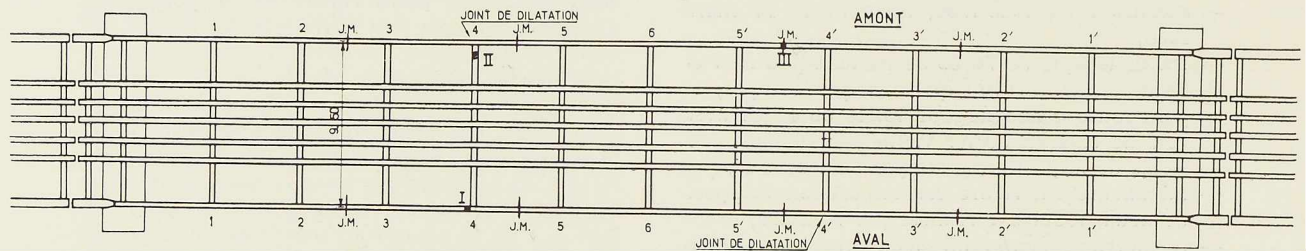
Vue en plan du pont d'Hérenthals-Oolen.
